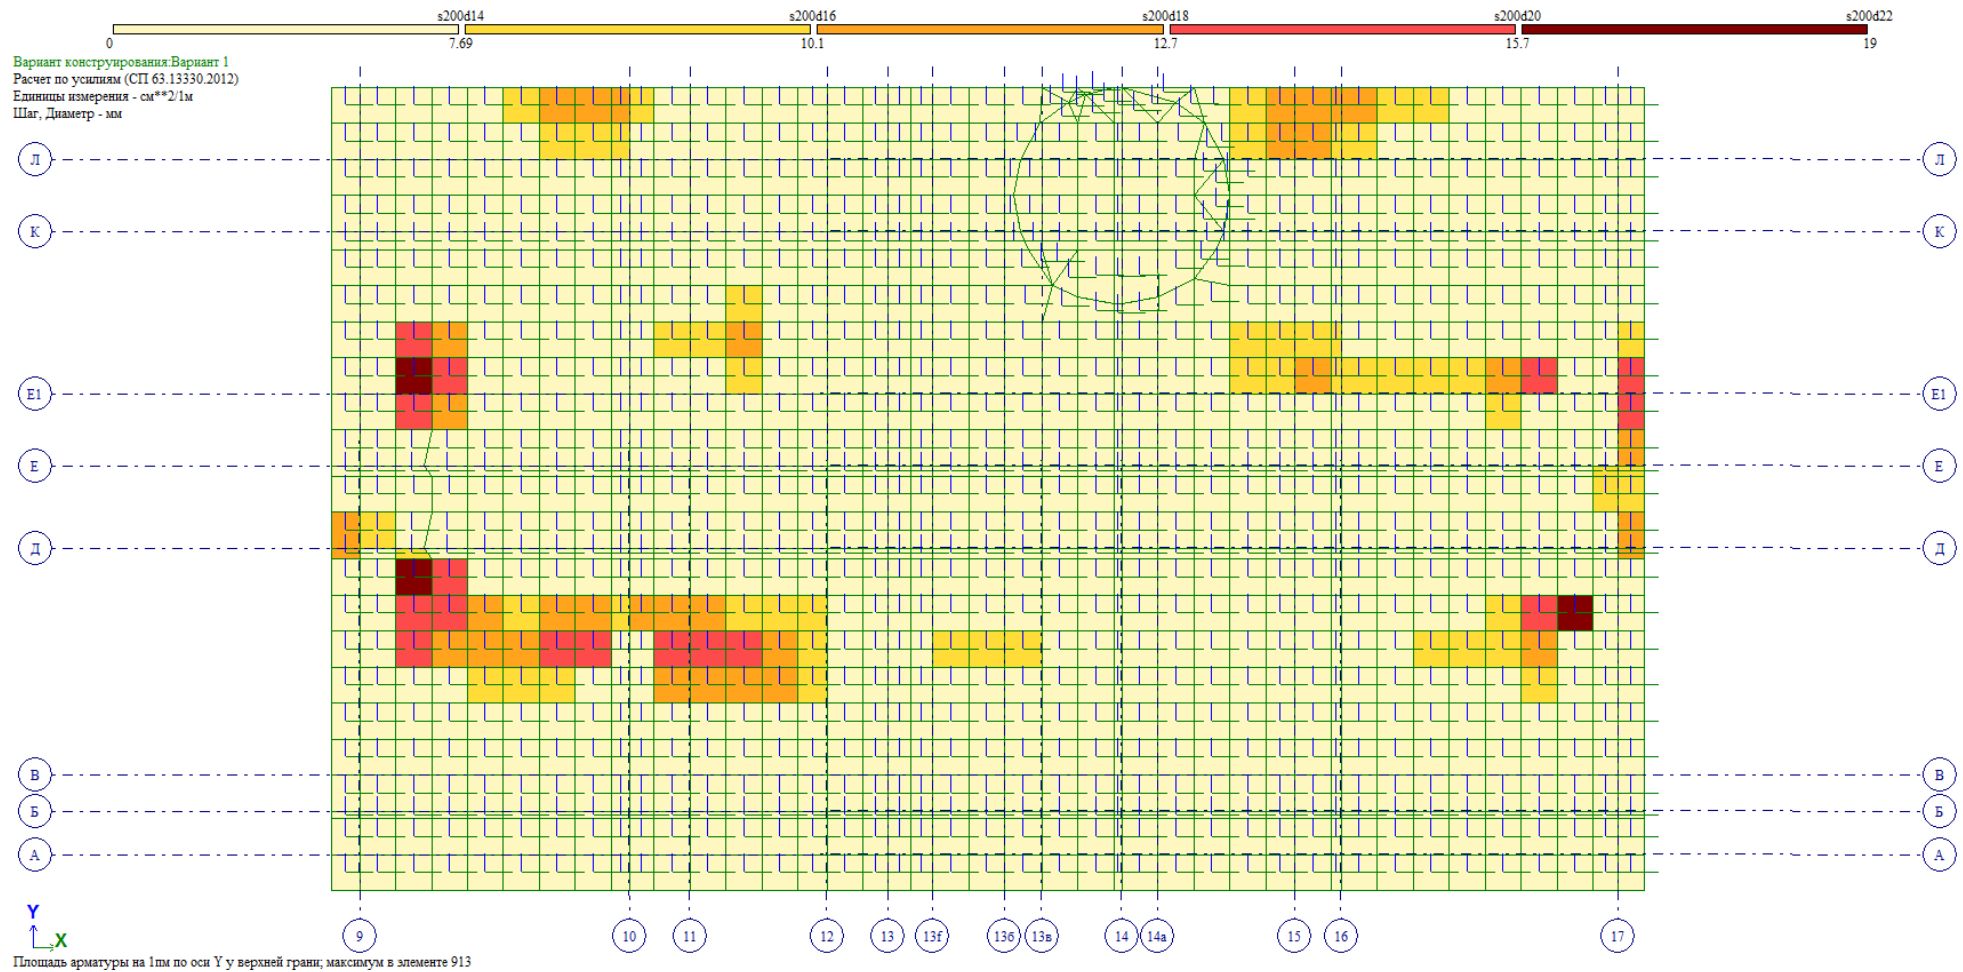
Площадь арматуры у верхней грани фундаментной плиты по оси Y (карстовая воронка расположена в осях 14/Л секции В)
